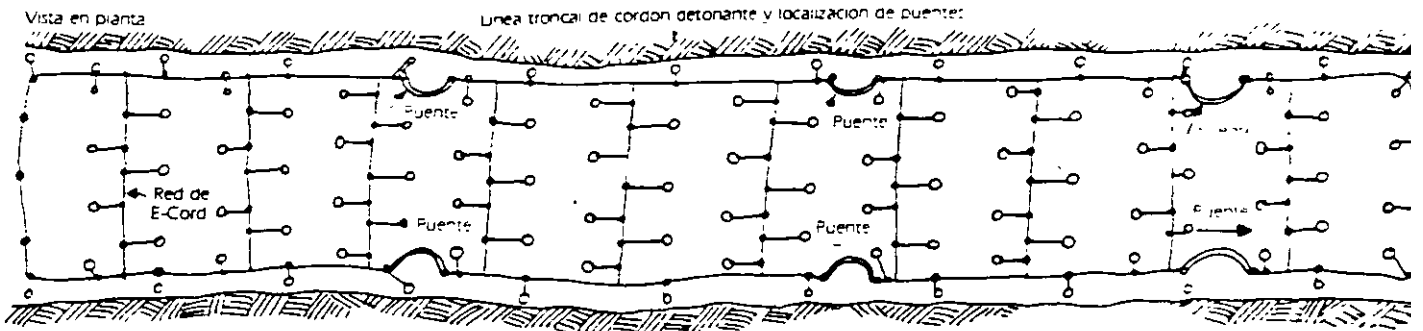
A. Conexión con "Gancho J" utilizado en un rebaje largo y angosto
